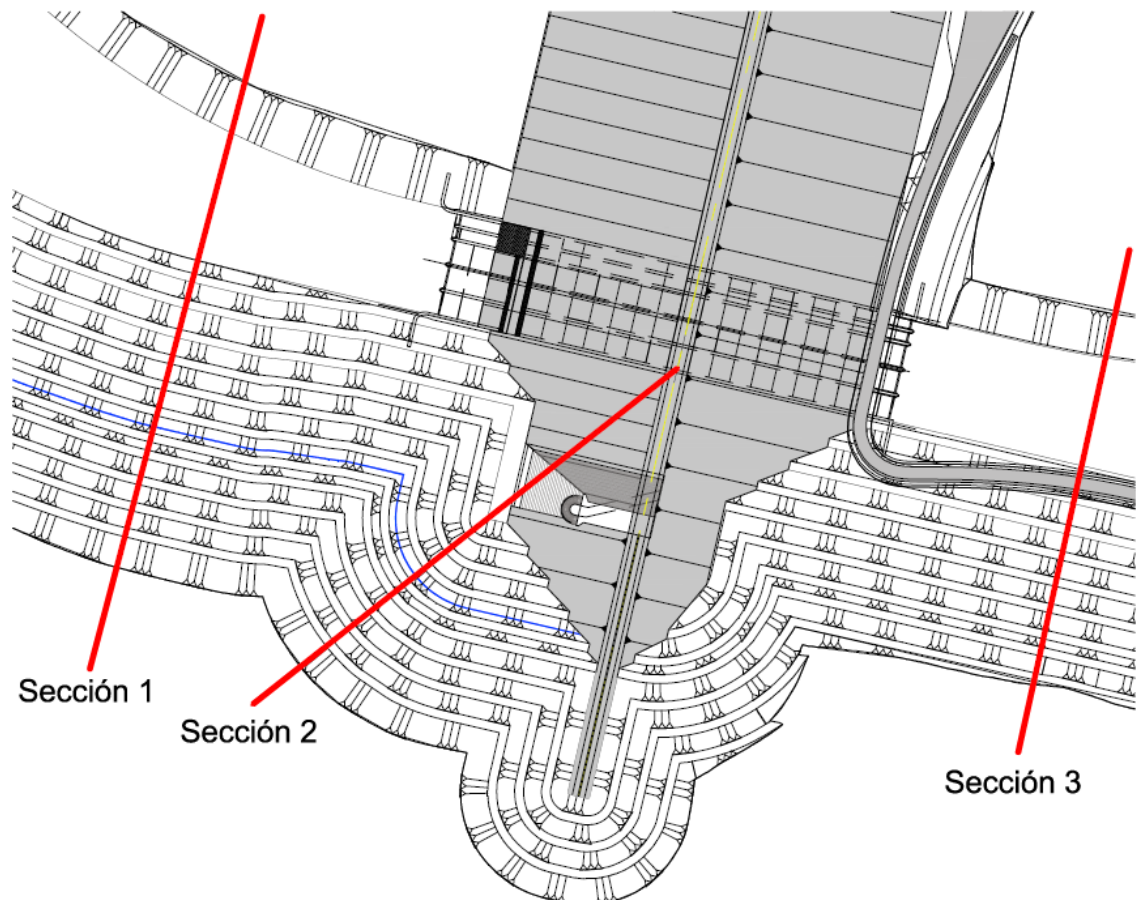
Planta Excavación Final en Canal y Estructura de Desvío
